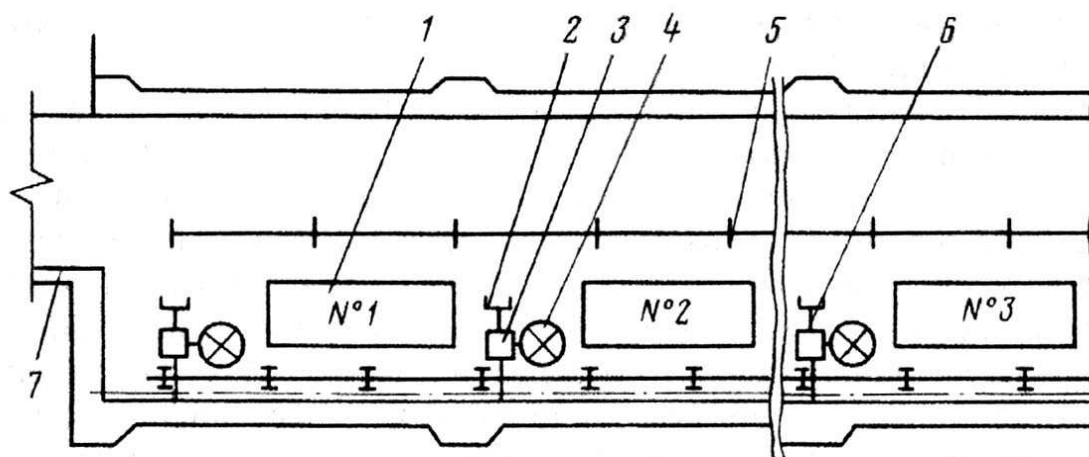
План расположения электрооборудования в зарядной камере:
